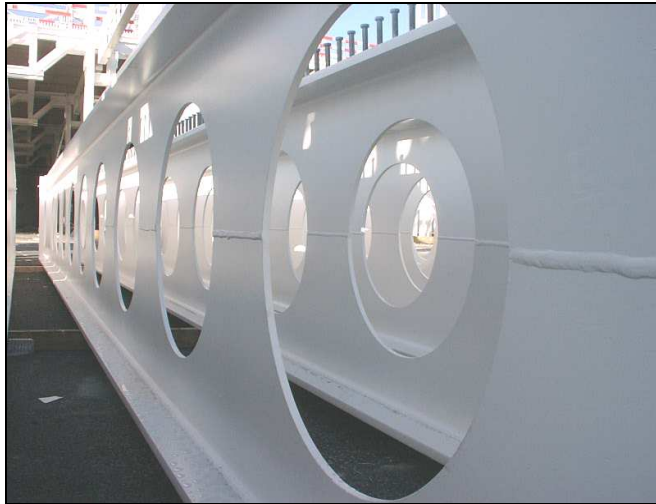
Vigas alveolares fabricadas con perfiles laminados en caliente
